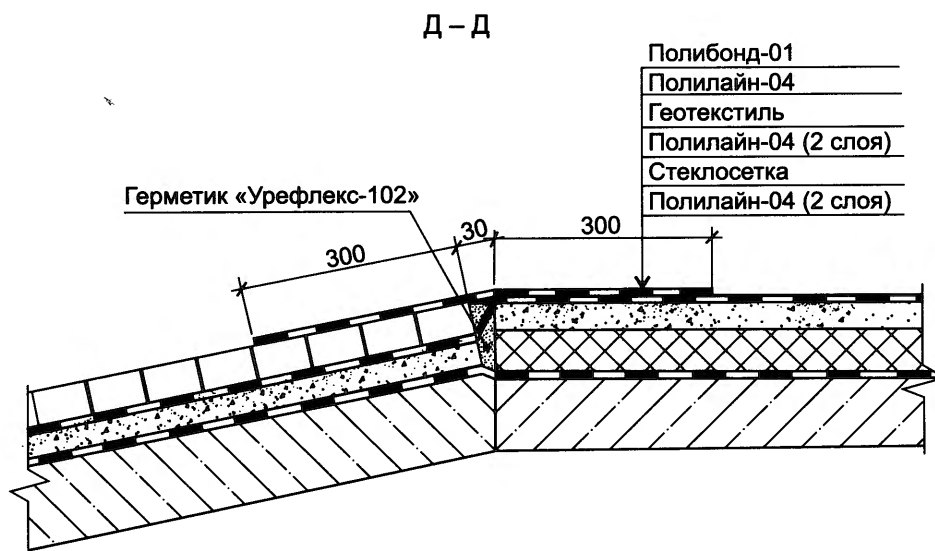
Гидроизоляция узла примыкания подъема к полу
